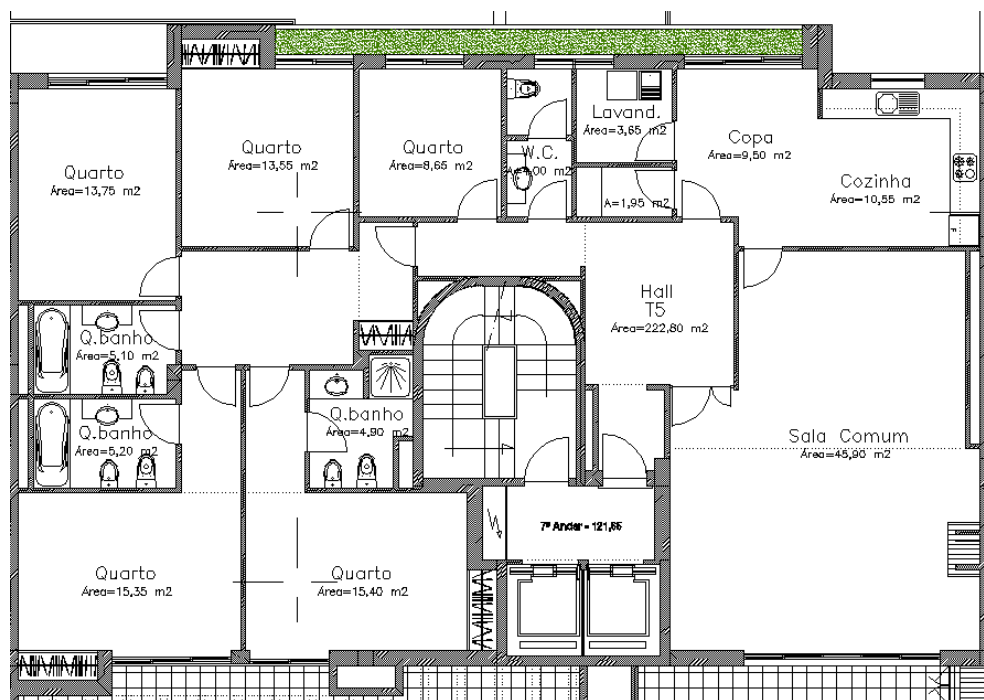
Planta da fração autónoma do 7º piso do Edifício A.
